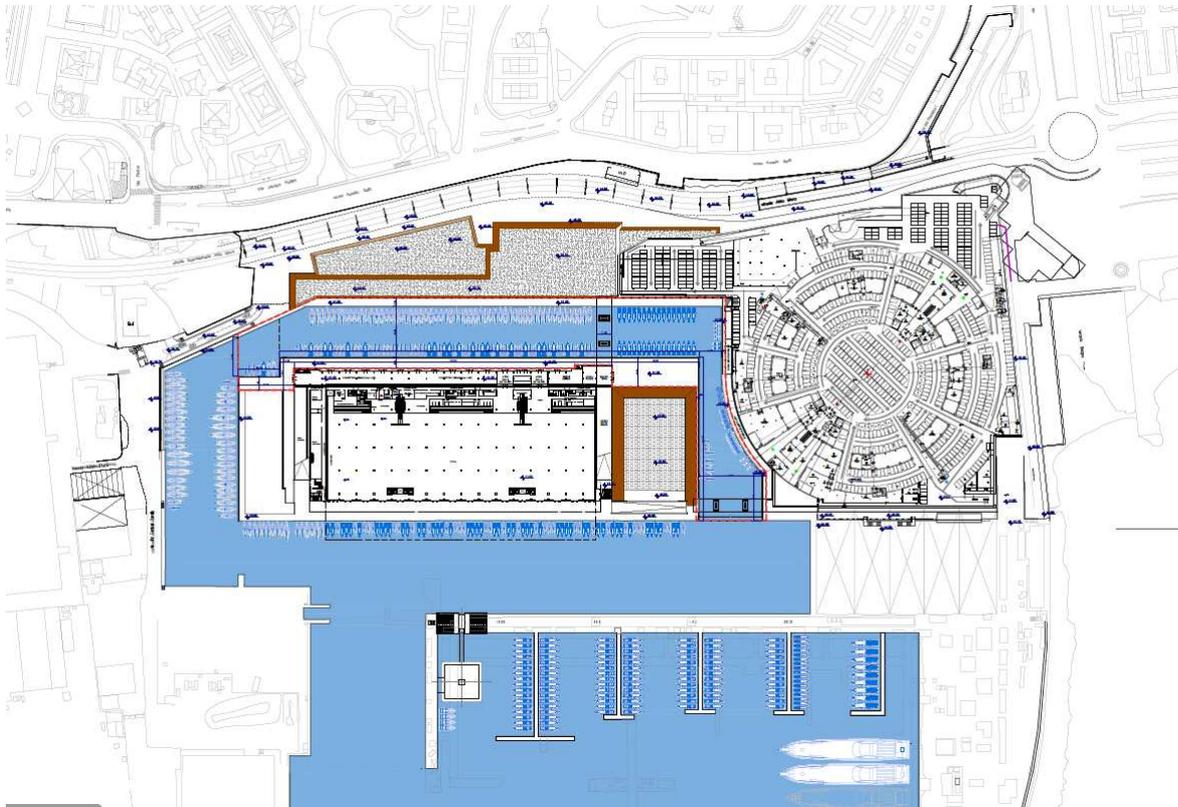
Stato di progetto. Planimetria generale a quota +1,20 (Stralcio elaborato T03-D-Ar del progetto definitivo).
